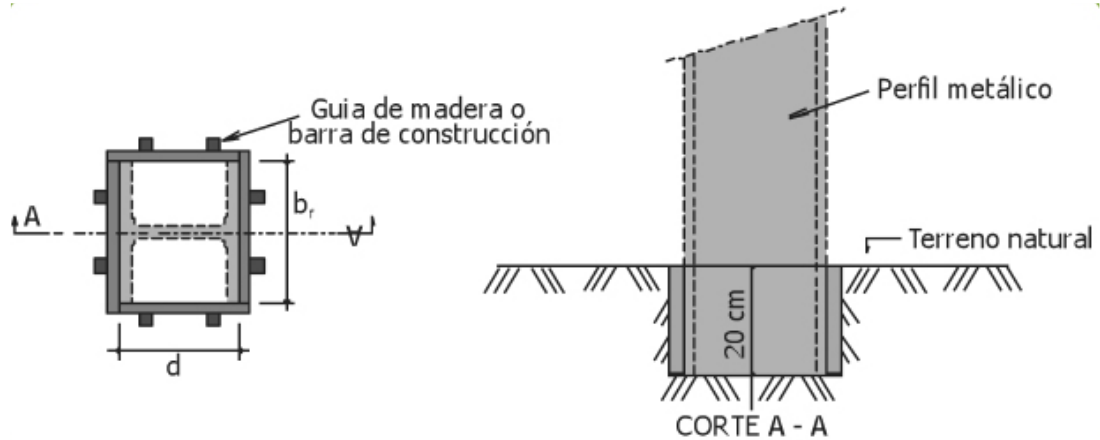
Guía de madera para el hincado. Fuente: (Gerdau Corsa, n.d.)
